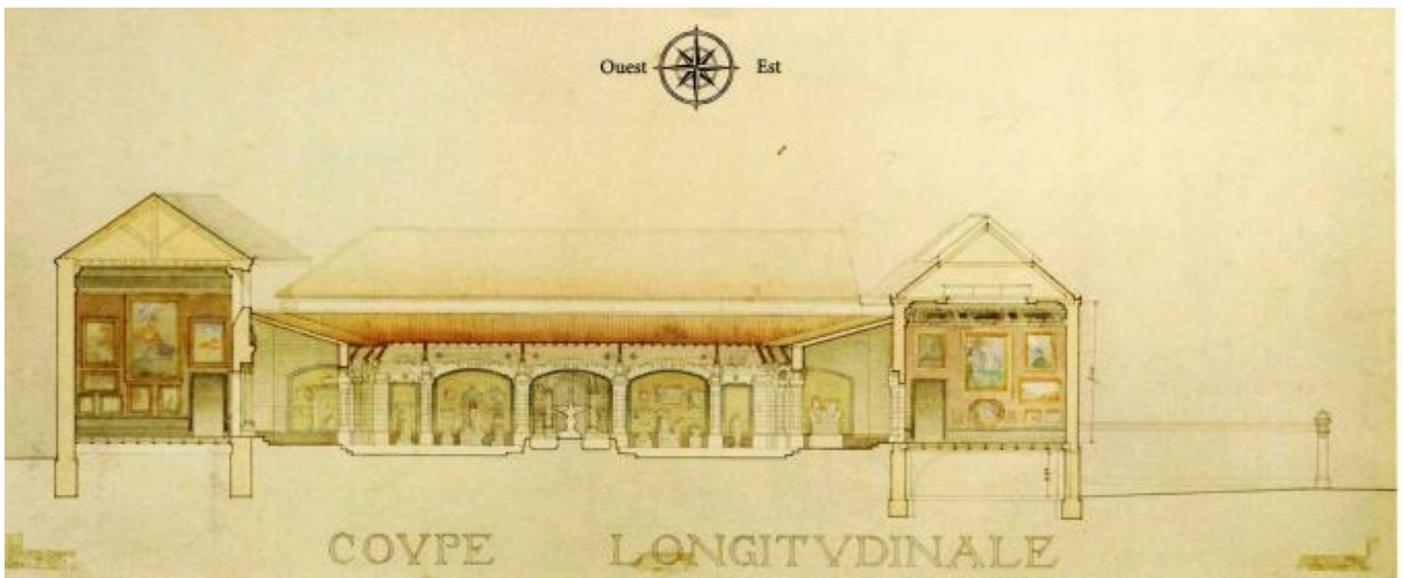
Avant-projet du musée en coupe longitudinale par Charles Planckaert
